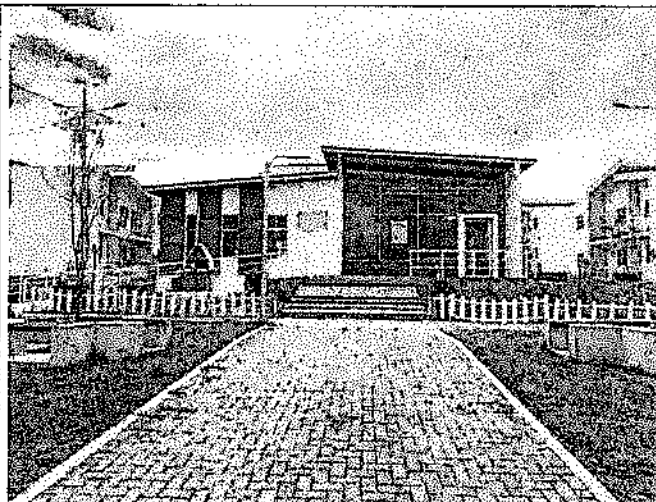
Vista Exterior – Bloques de 1 planta.
